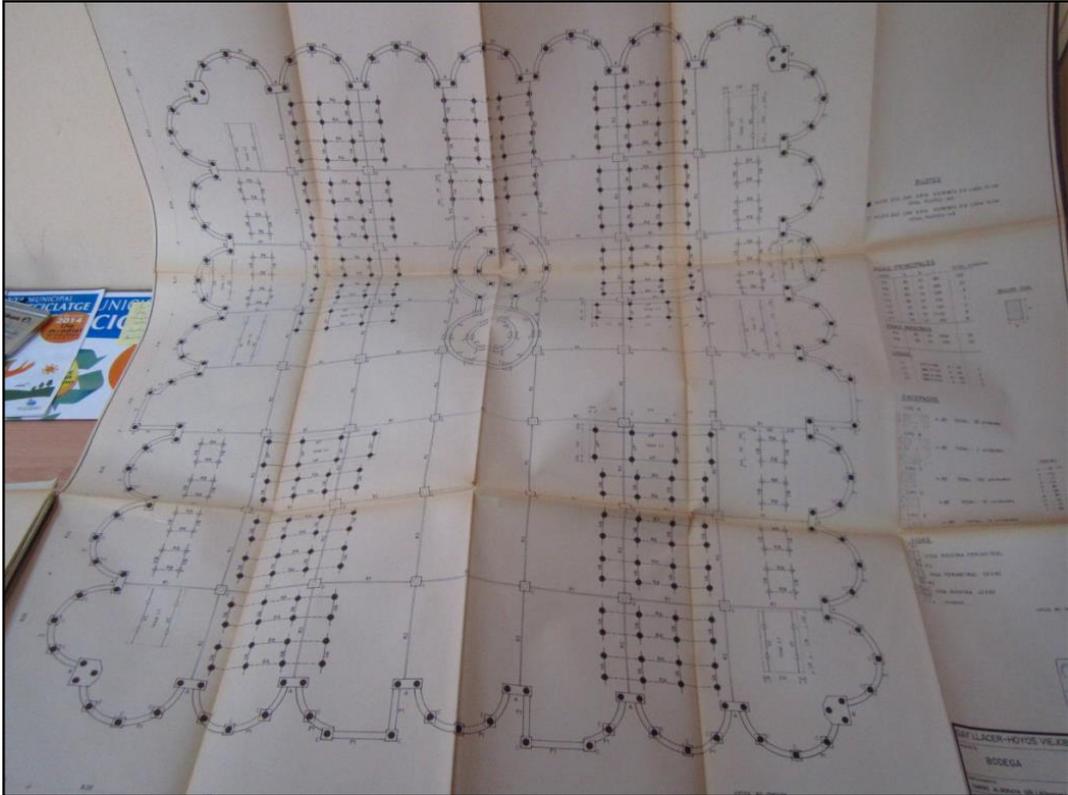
Plano nº4 de cimentación del proyecto. (Fuente: AMA)
